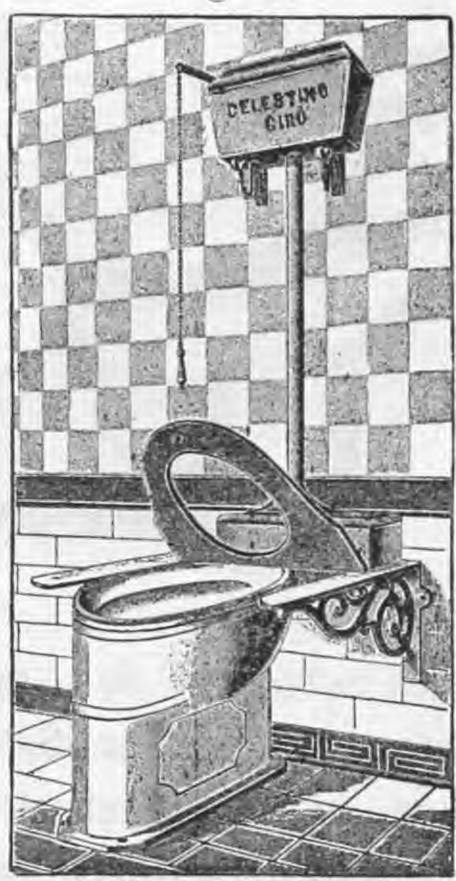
Prospetto (Closetto) Fig. 22 - Sezione
